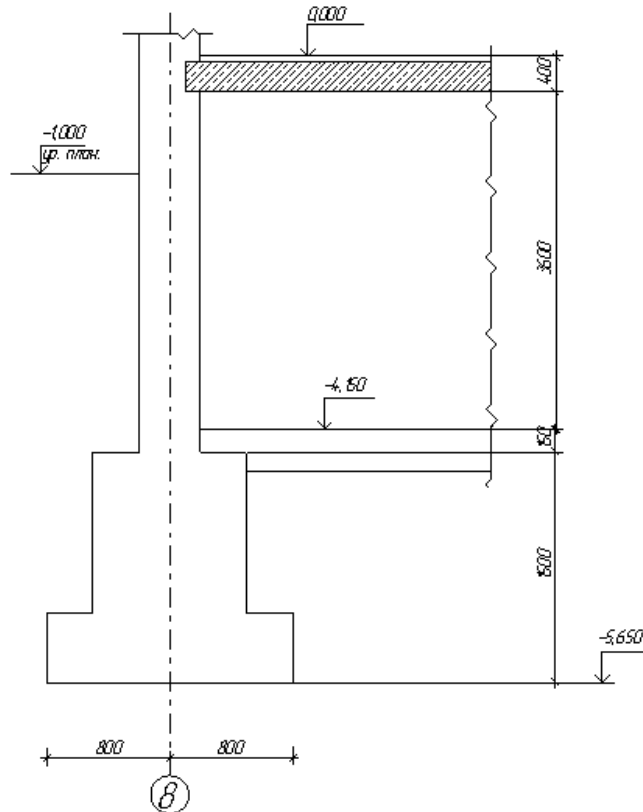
Попереднє конструювання фундаменту під колону з підвалом
